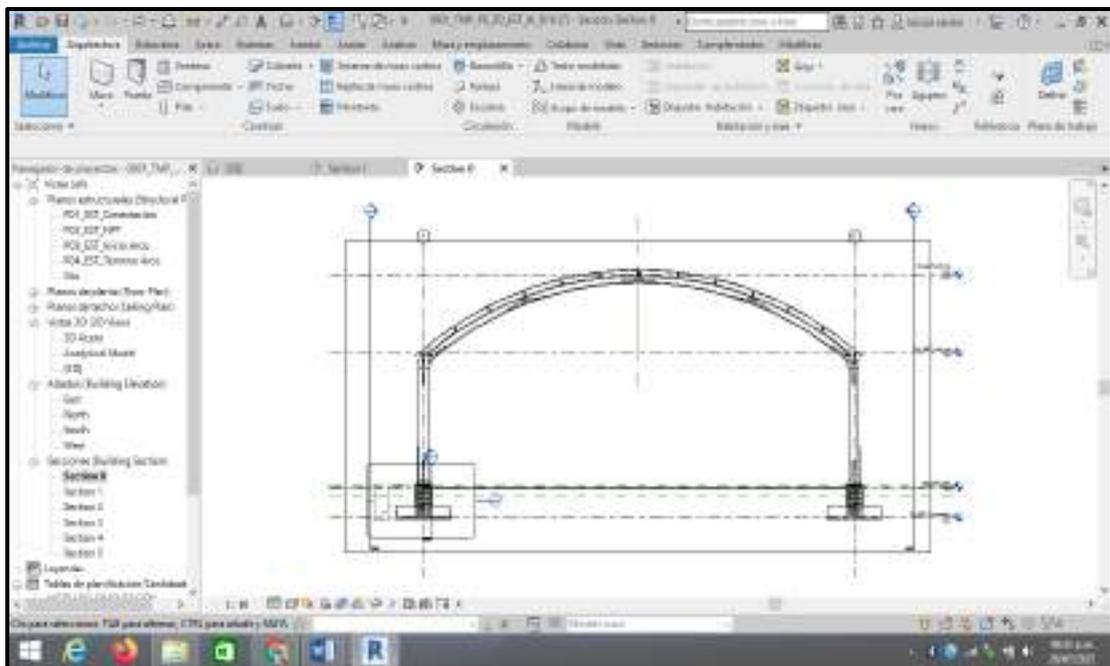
Vista frontal de la estructura parabólica de la cobertura metálica.
